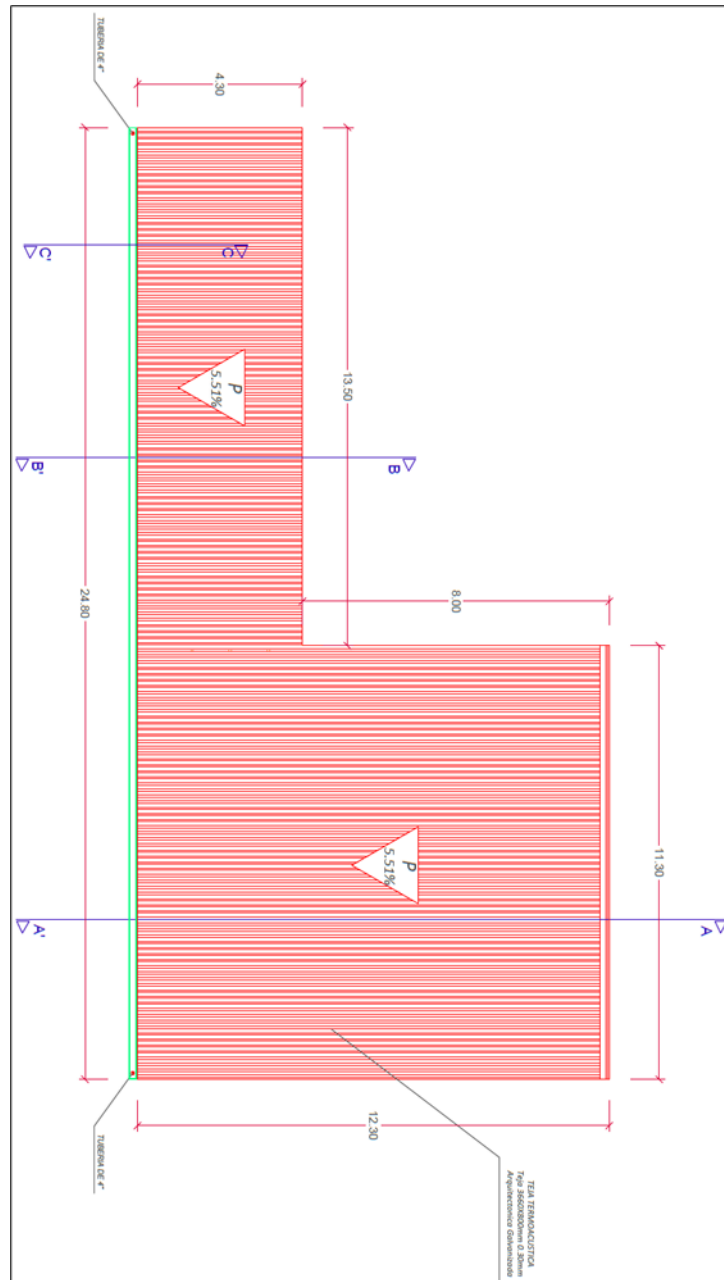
Vista en planta de techo de la estructura 3 del Centro Vida.
